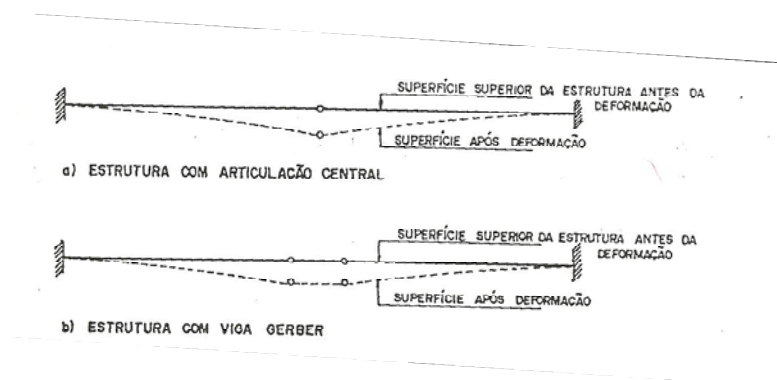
Deformação das estruturas com articulação e viga Gerber (Fonte: CARVALHO, 1987)
